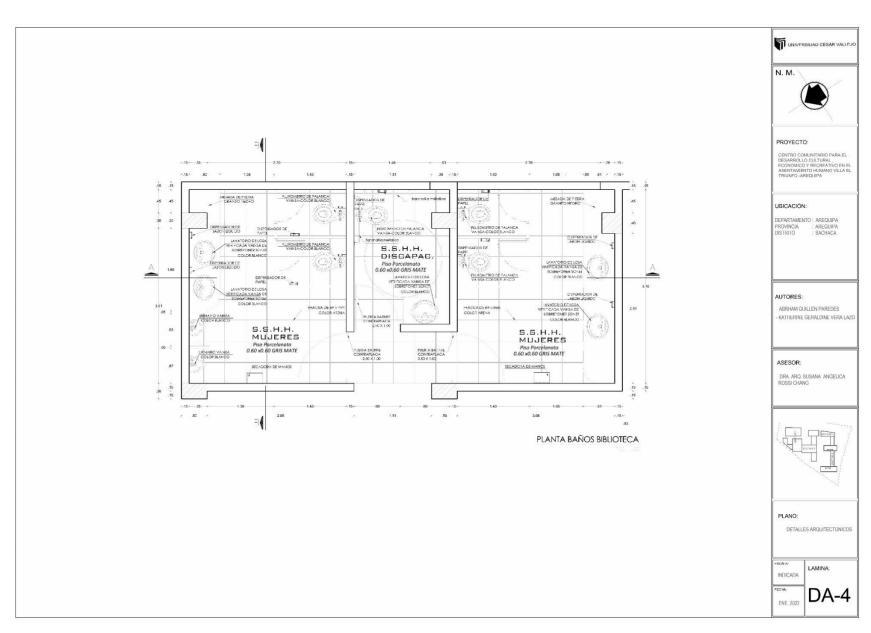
Plano de Detalles Arquitectónicos (Planta - Baño Biblioteca) - Elaboración propia
